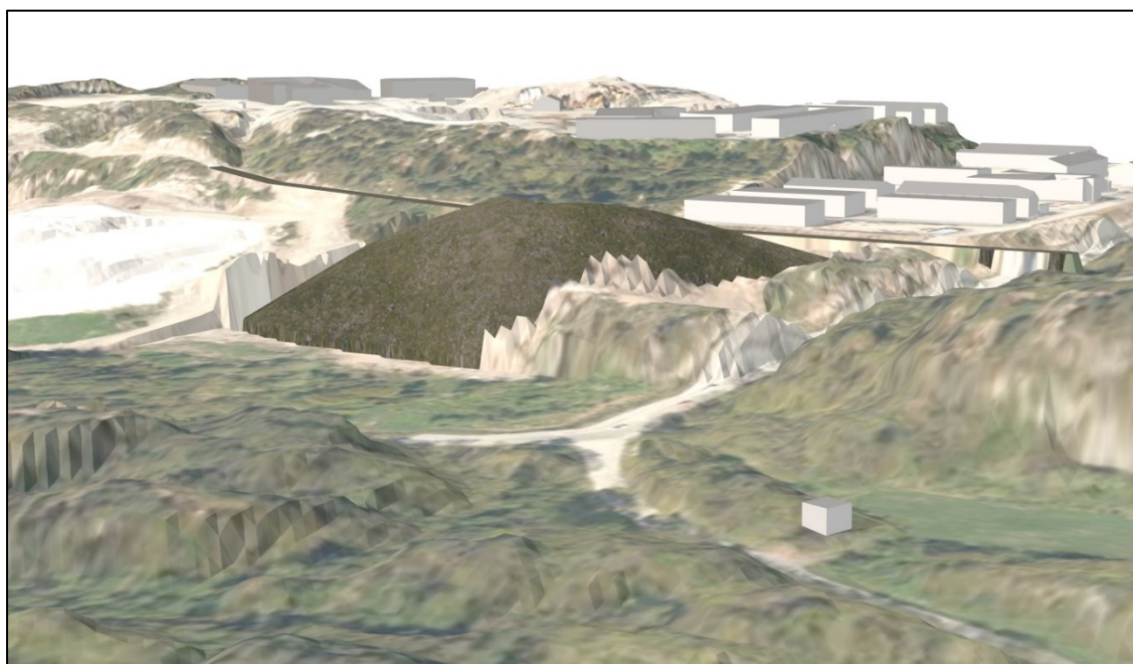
Planert kote +30 (Kilde: TT anlegg)
